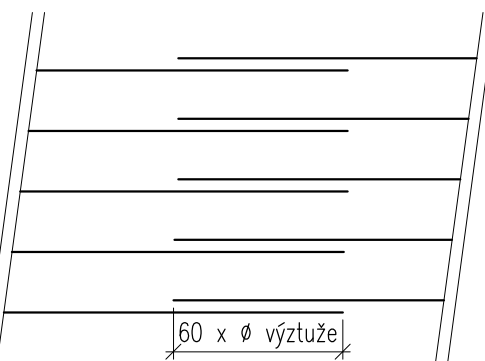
PROVÁZÁNÍ ROHŮ VĚNCŮ V1 PŮDORYS
